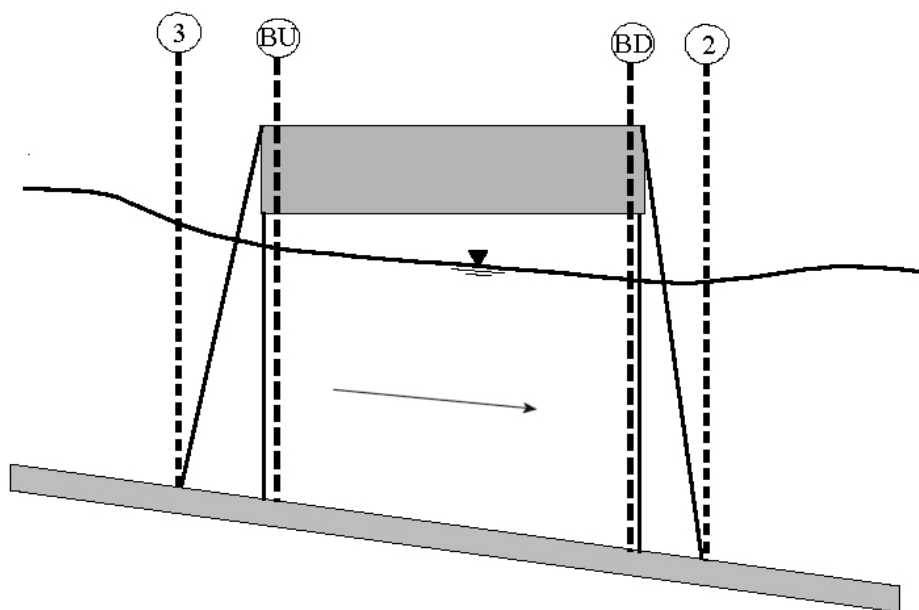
Schema sezioni per il calcolo del sovrizzo indotto dalle pile dei ponti
